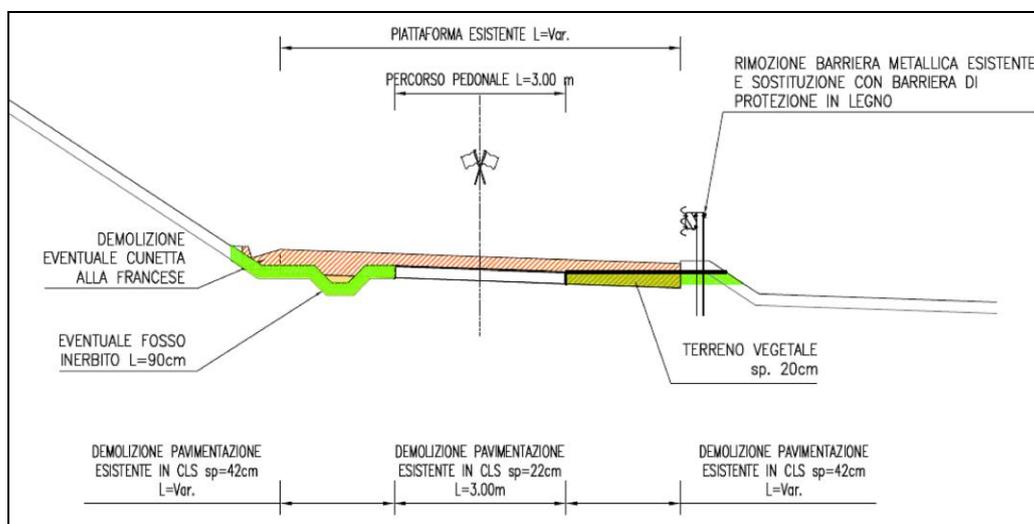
Schema demolizione pacchetto di pavimentazione in cls
